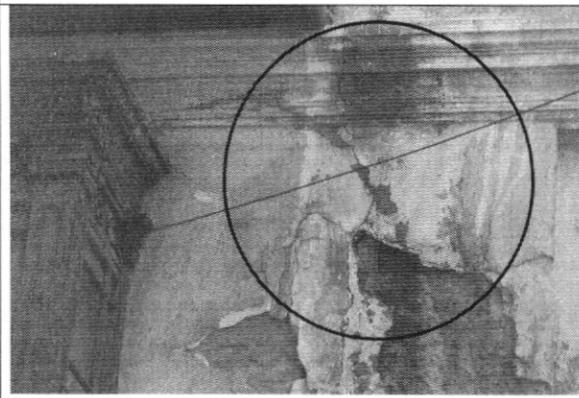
Desprendimiento de acabados y fisuras en muros de segundo piso
